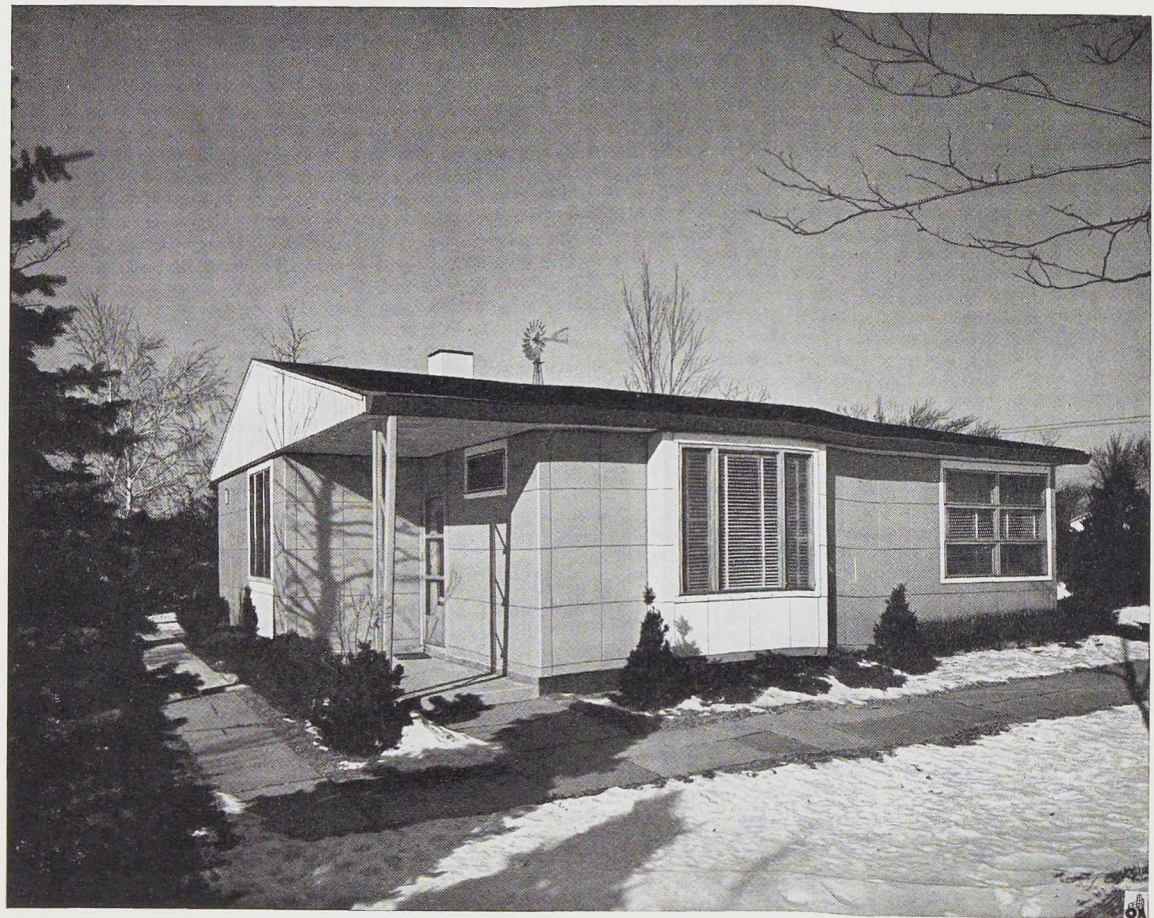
Vue d'ensemble d'une maison préfabriquée « Lustron Home ». Photo Hedrich-Blessing.
